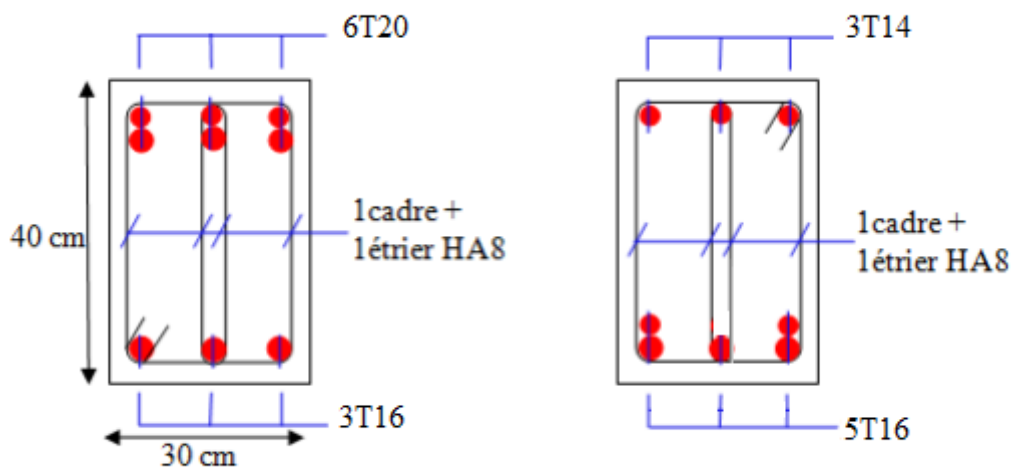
Schéma de ferrailage de la poutre principale.
